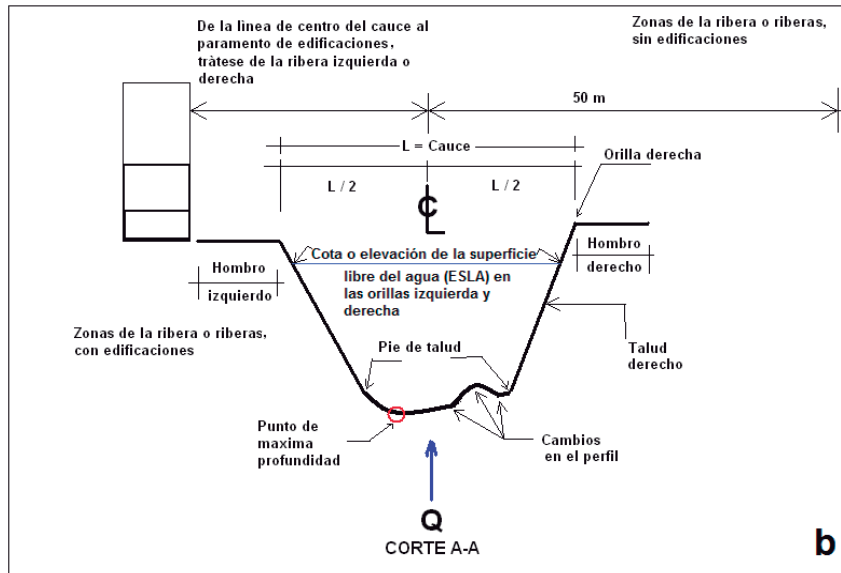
Lineamientos para el levantamiento de secciones transversales. Sección transversal.
